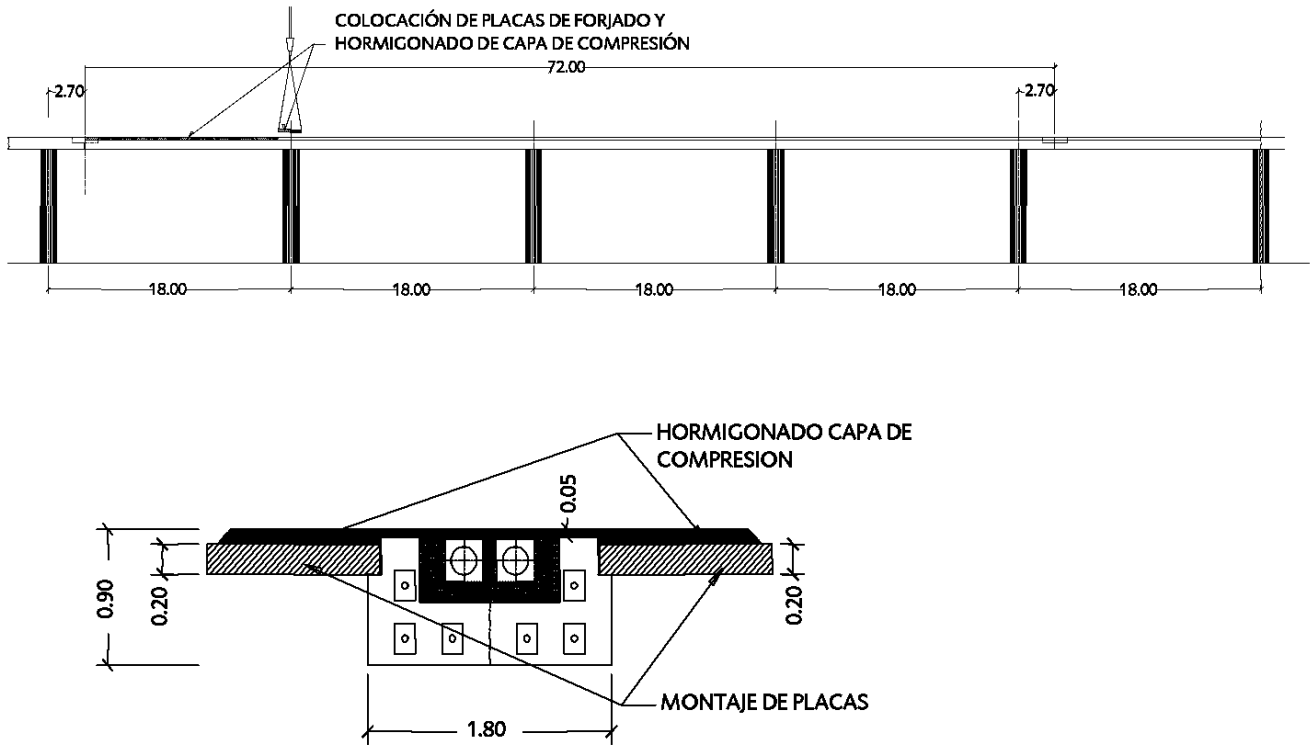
Proceso constructivo, instalación de las losas alveolares, colocación de la malla de reparto y hormigonado de la losa de compresión.
